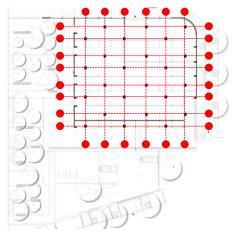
Estructura aporticada plaza de mercado gramalote, Santander Fuente: Mercado, Archdaily
